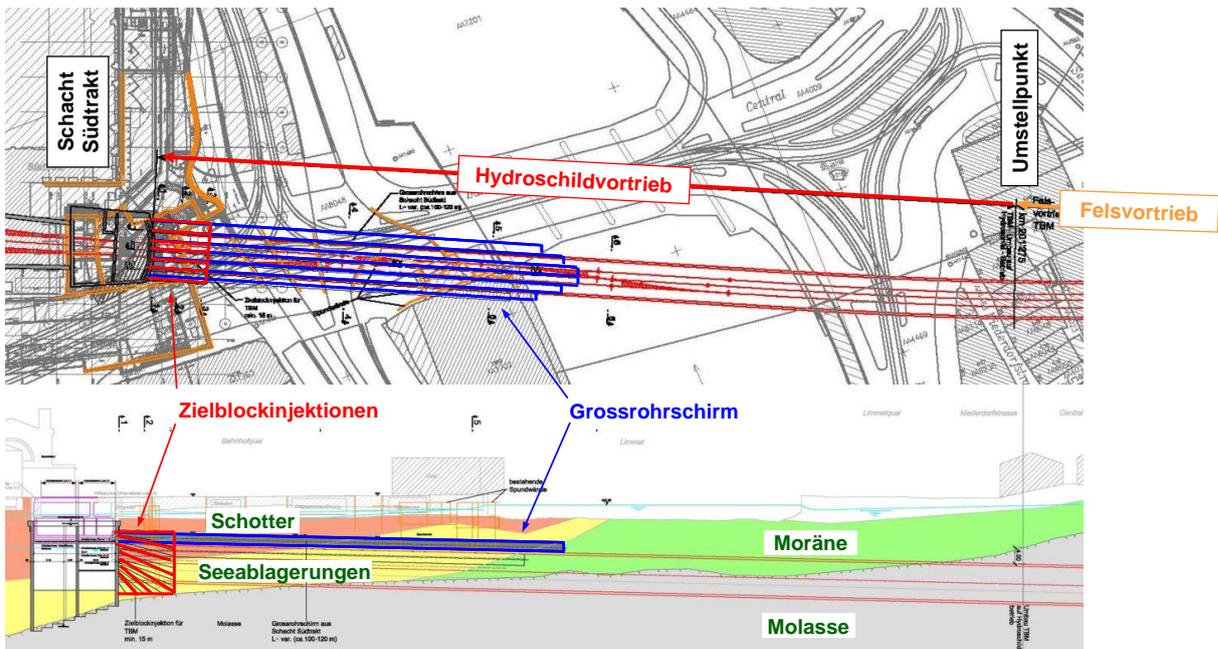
Bauhilfsmassnahmen Grundriss und Längsschnitt
